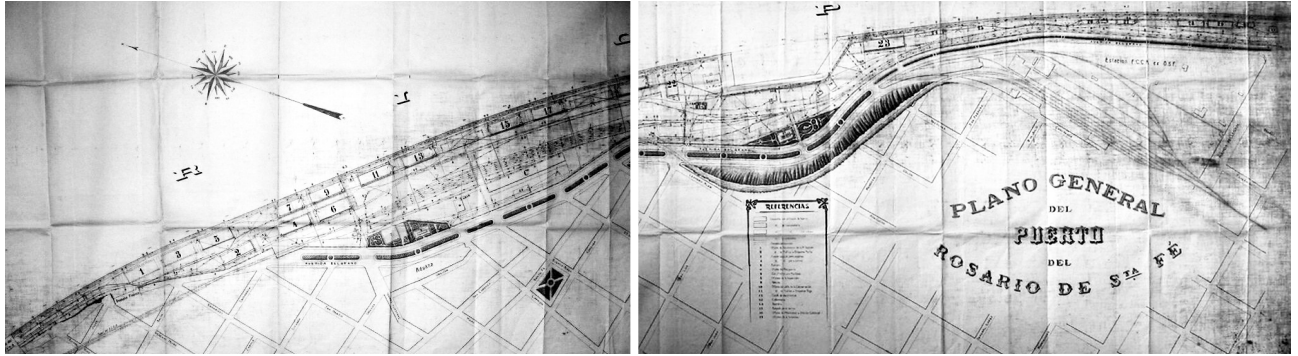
| Plano General del Puerto del Rosario de Santa Fe, detalle costa central (c. 1916). Fuente: Archivo ENAPRO.
